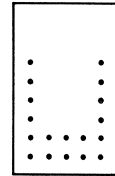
Voorbeelden van beschouwde balken en kolommen.
